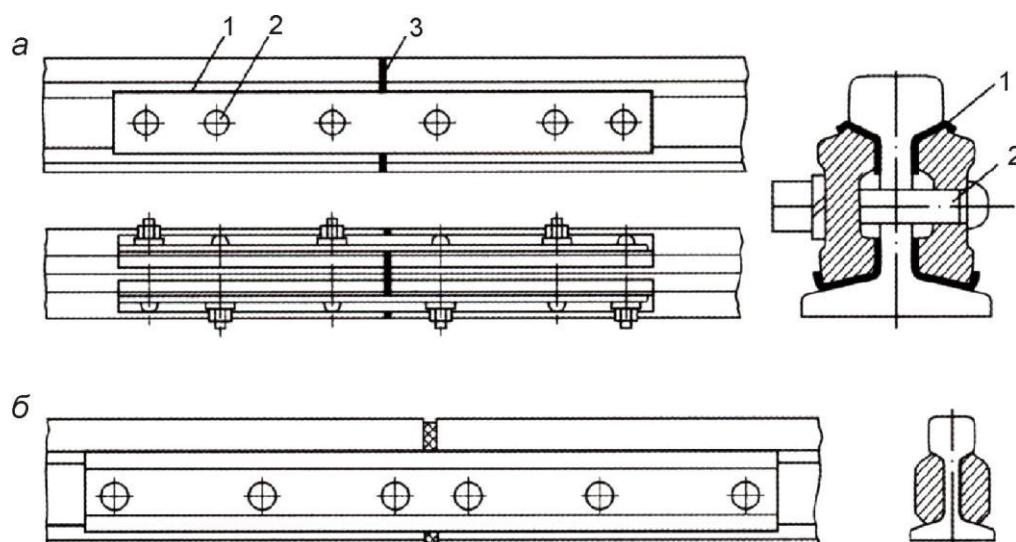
Клееболтовые стыки: а – с подстроганными типовыми накладками; б – с накладками, облегающими пазуху рельсов; 1 – клеевое соединение с изоляцией из стеклоткани; 2 – изоляция болта, оклеенного стеклотканью; 3 – торцевая изоляция из фибры, пропитанной клеем
